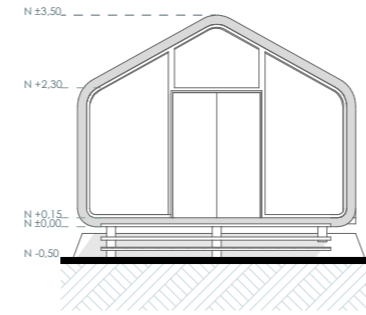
Elevación frontal Wikkelhouse. Fuente: Autores, 2023
